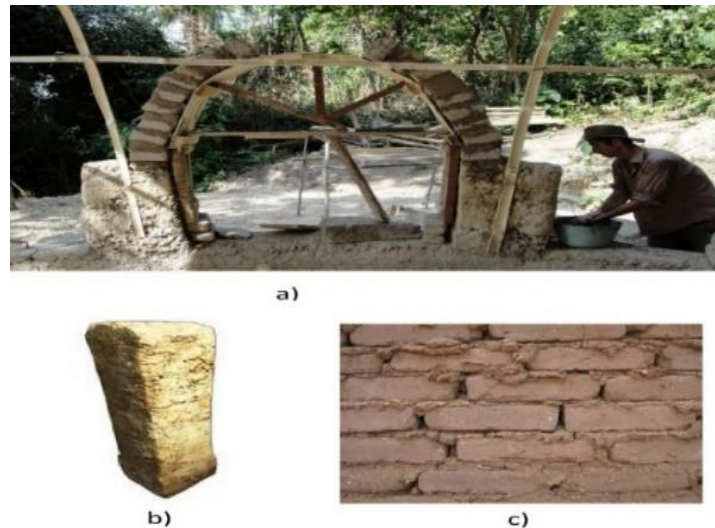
a) Construção de arco em adobe (reservanaturalvictoria.blogspot.pt, (2017)); b) Pilar de adobe (ark.gamepedia.com, (2017)); c) Paredes de adobe (pinterest.pt,(2017))
